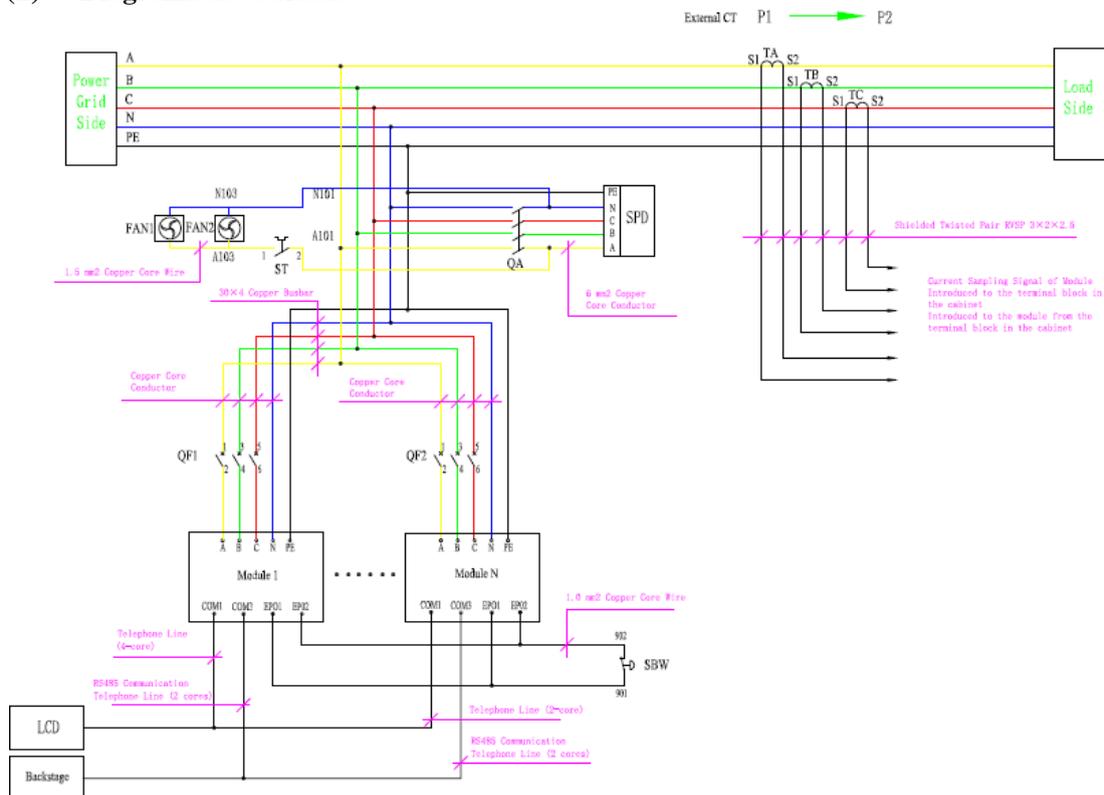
Diagrama esquemático de cableado típico para instalación tipo gabinete
